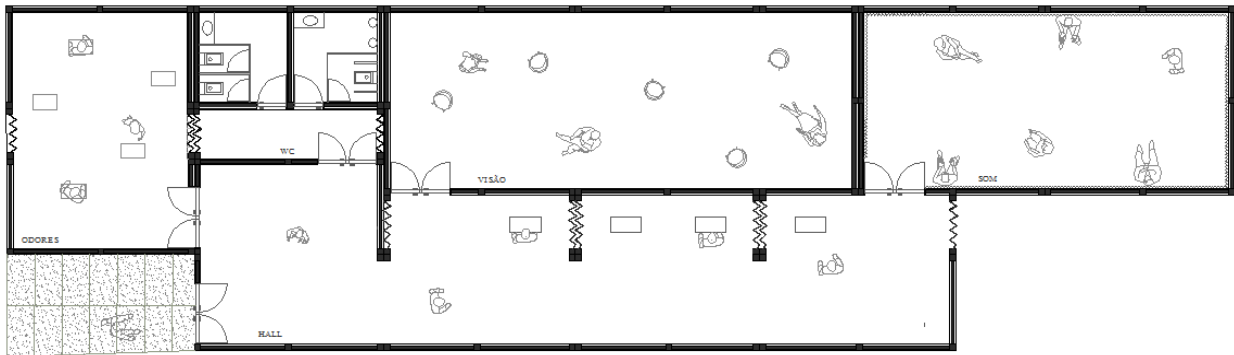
Planta do piso e corte da proposta. Escala 1 | 100.
